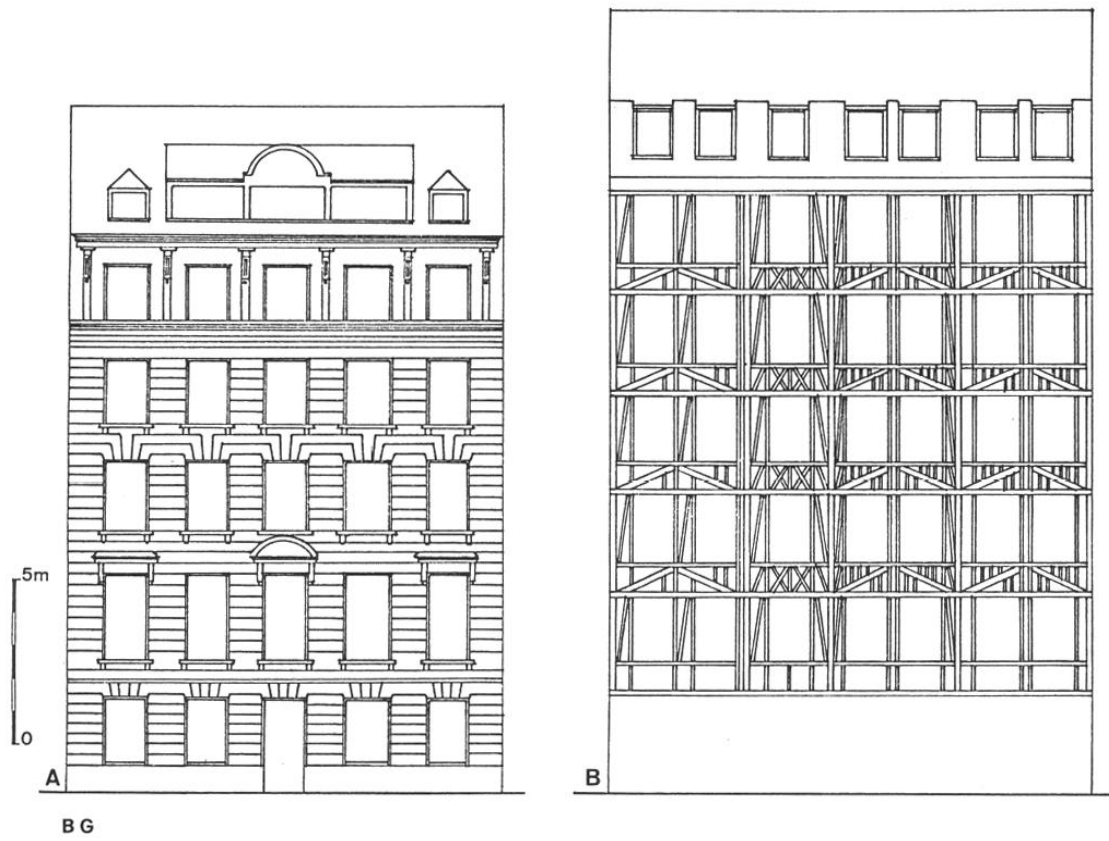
Exemples d'édifices construits entre 1750 et 1799, probablement des immeubles de rapport.
